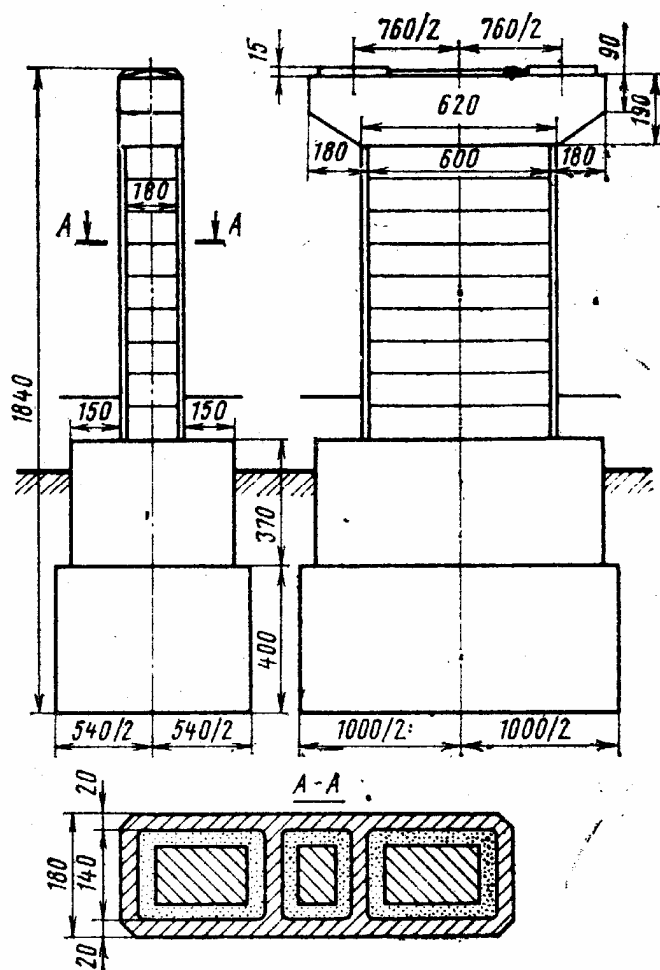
Сборно-монолитная опора с железобетонным ригелем
